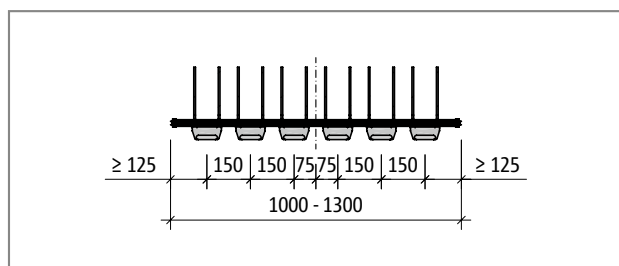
Schöck Tronsole® tipo T-V6-H...-L1000 - L1300, pianta del prodotto
